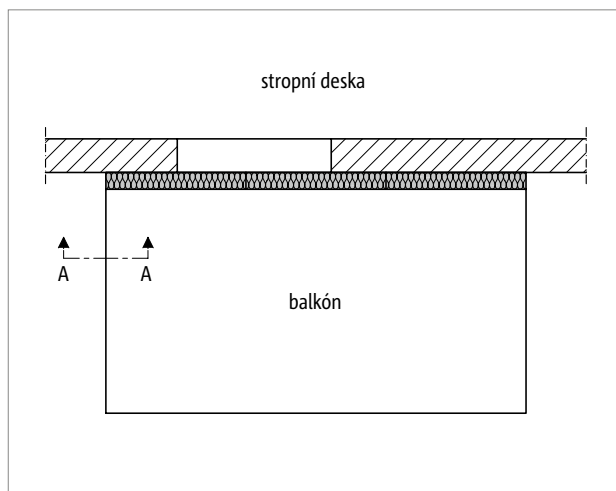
Schöck Isokorb® CXT typ KL: Napojovací stavební výztuž u nepřímého uložení
